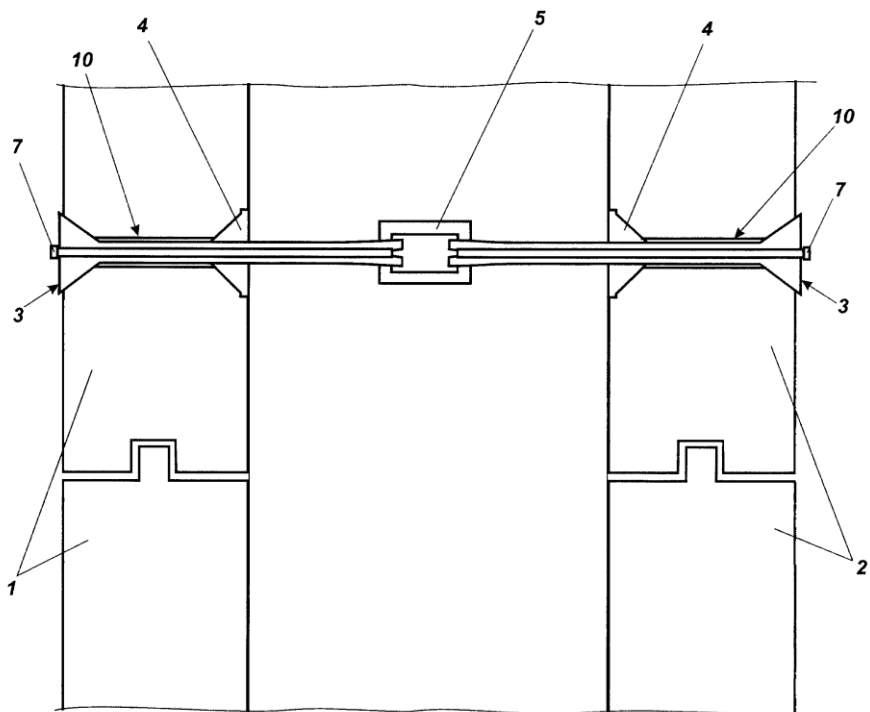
Фрагмент зоны соединения элементов комплекта несъемной опалубки [4], где; 1 – наружная опалубка, 2 – внутренняя опалубка, 3 – анкер, 4 – фиксатор, 5 – дистанцер, 7 – дюбель, 10 – отверстие
